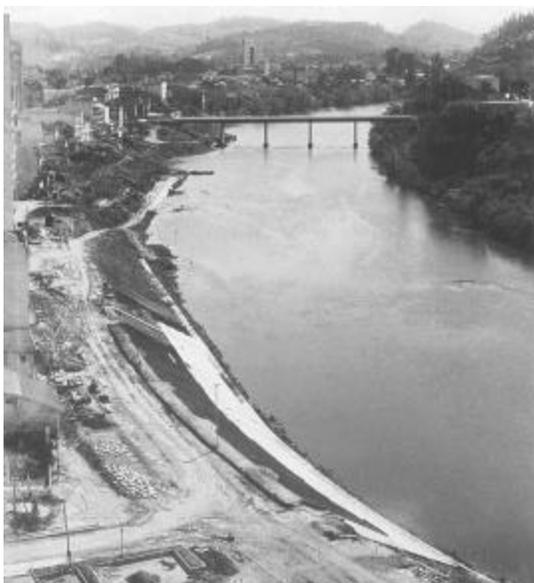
Início da construção da Avenida Beira-Rio em 1968.
